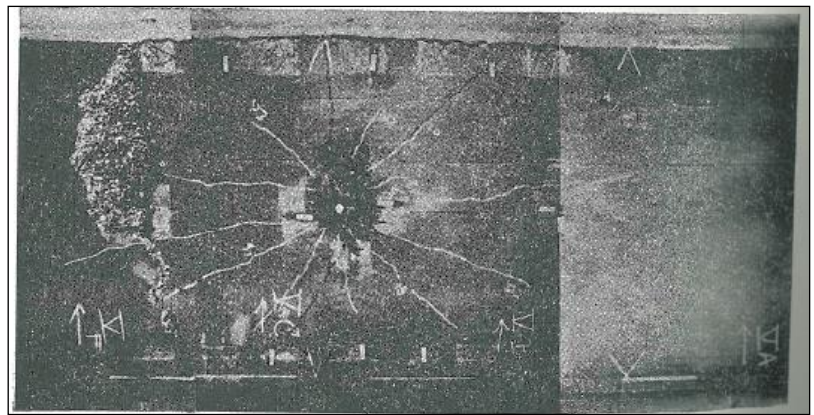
Photo de la rupture de la dalle II (en face inférieure)
